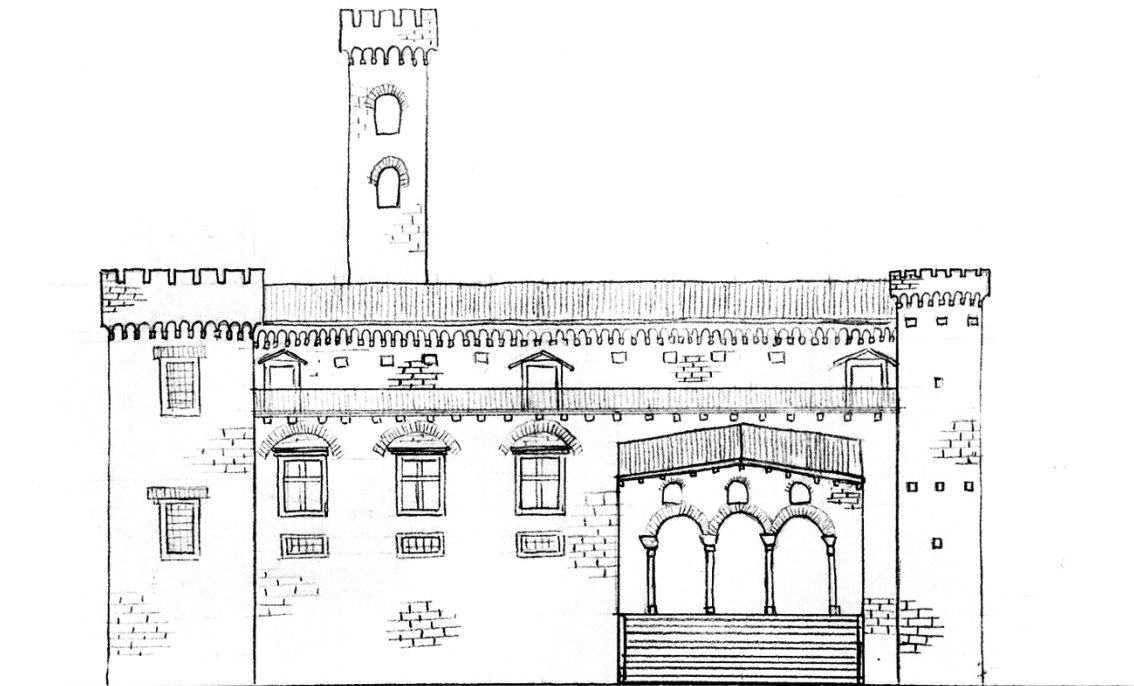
Reconstrucción de la fachada del Palacio de los Senadores.
